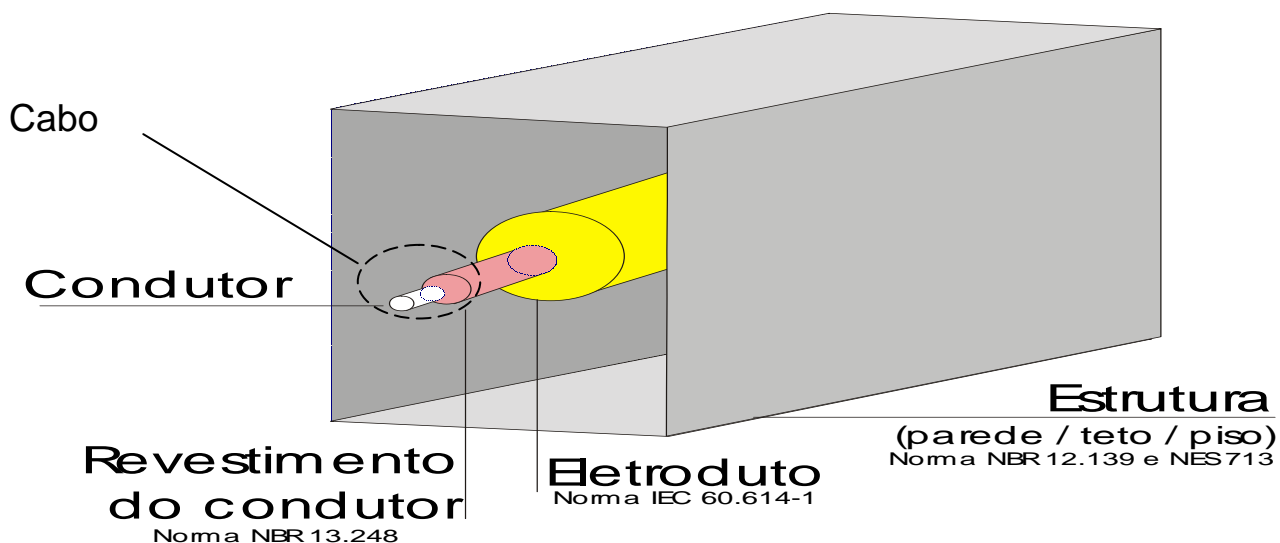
Detalhamento da interface cabo – estrutura da edificação (proposto).
